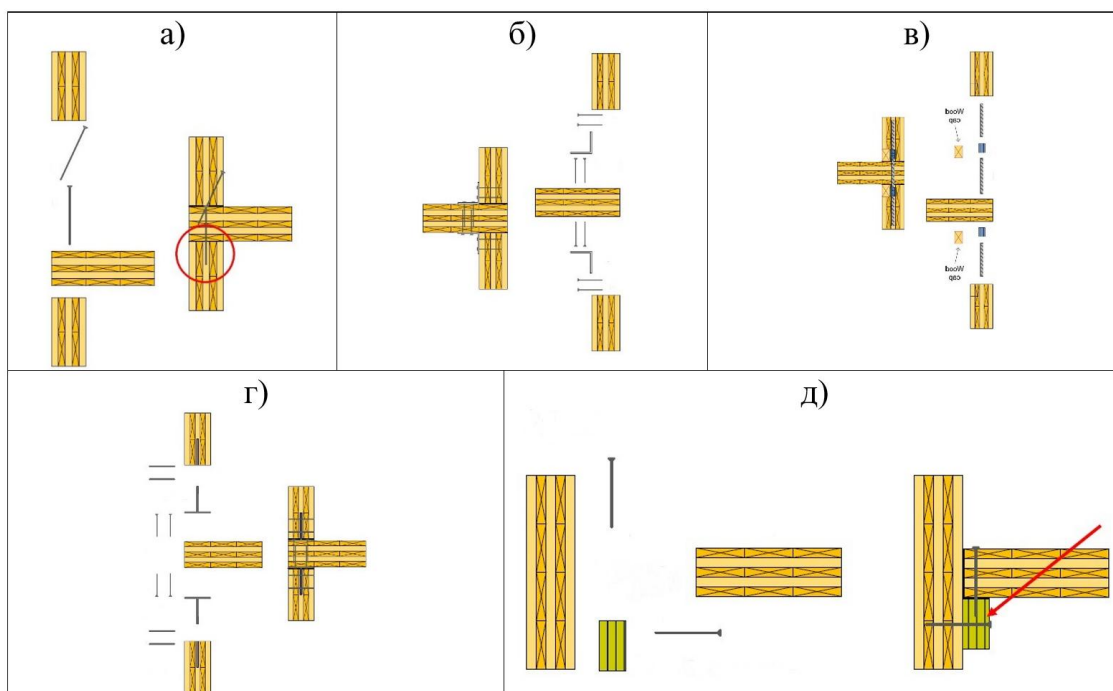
Виды соединения стеновой панели с панелью перекрытия
